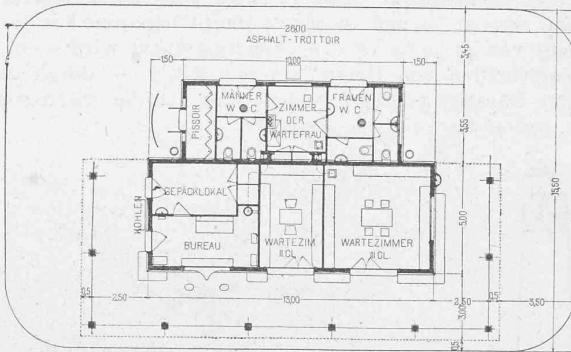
Birsigthalbahn-Station. — Grundriss 1:300.
